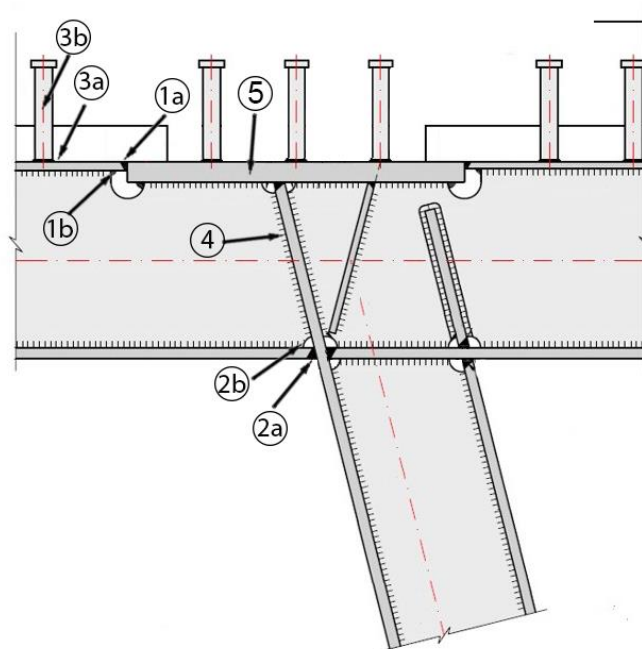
Pormenores de ligação da travessa superior não escorada ao caixão metálico
